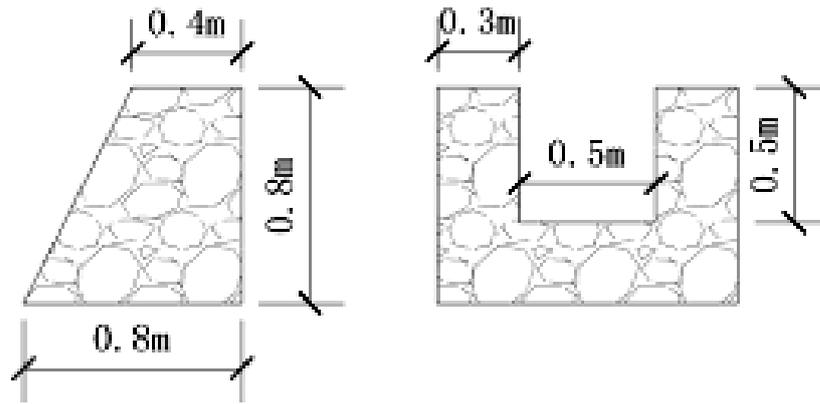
植生槽外侧挡墙及内侧排水沟剖面图
